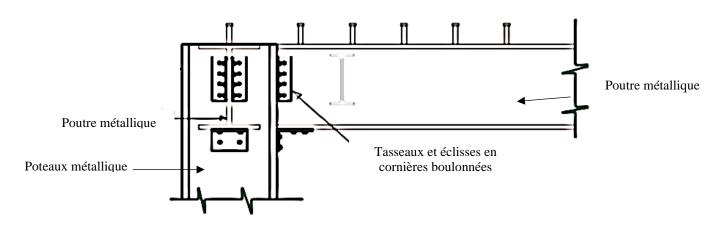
Assemblage poteau poutre Source : Marc Landowski et Bertrand Lemoine « concevoir et construire en acier » © Arcelor, Luxembourg, 2005
